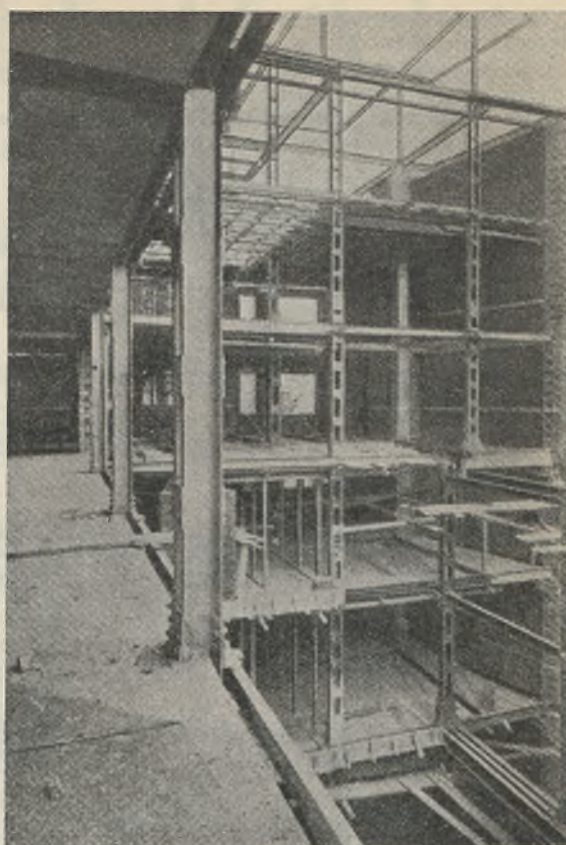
Stahlskelett mit teilweise einbetonierten Decken.
